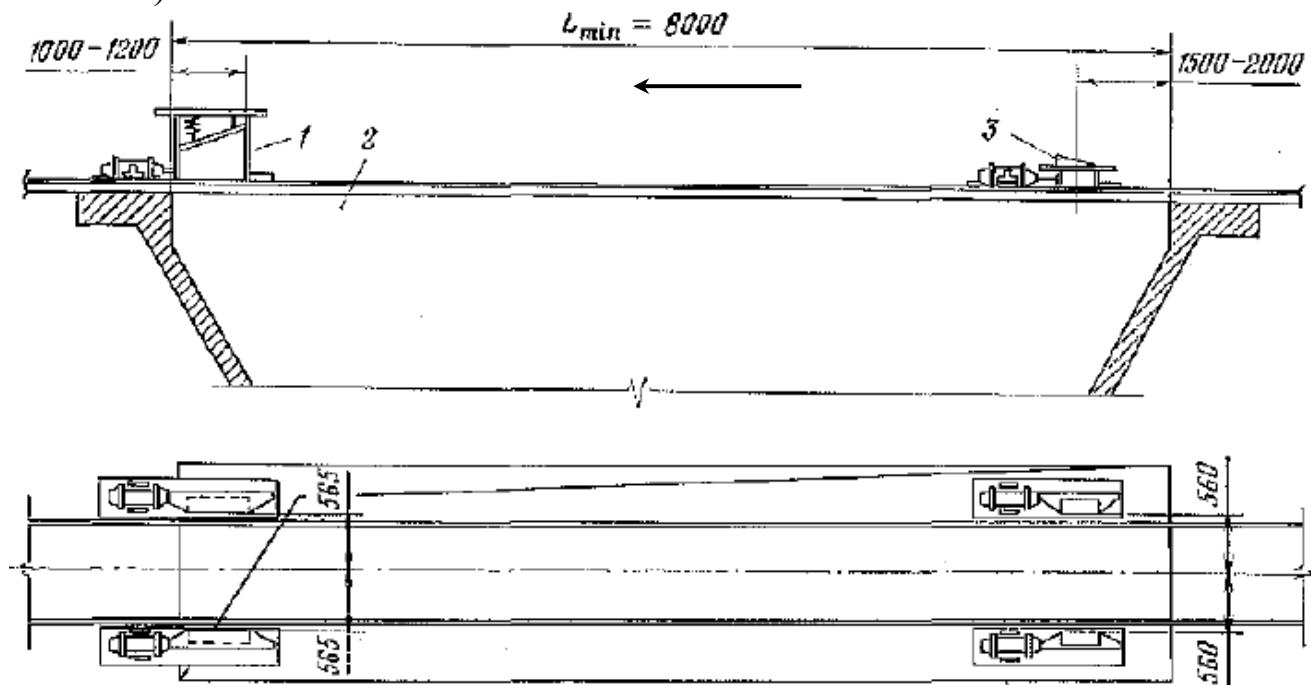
Оборудование пункта разгрузки вагонеток ВДК и секционных поездов ПС
